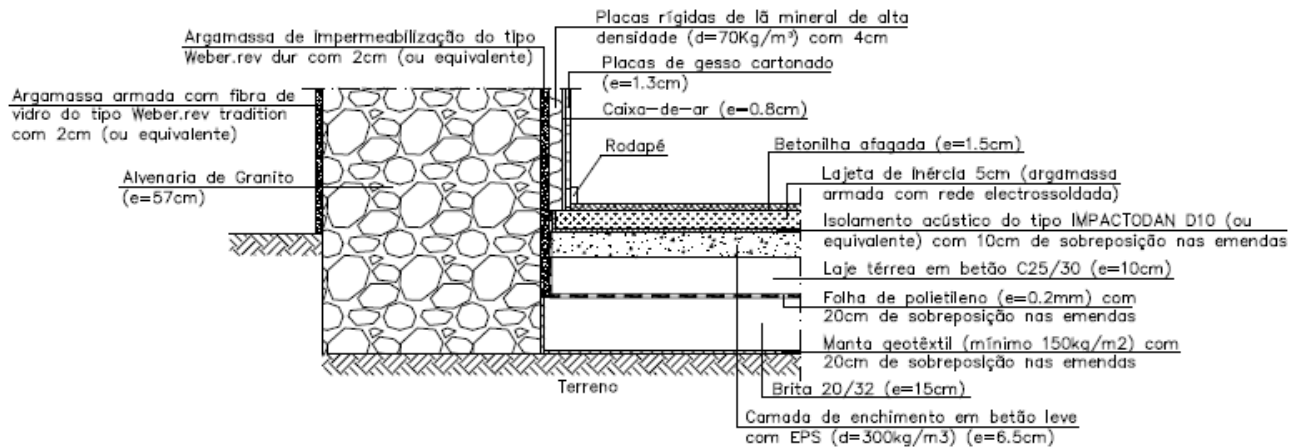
Pormenor de ligação da parede exterior com o pavimento térreo (Projeto de CT)
